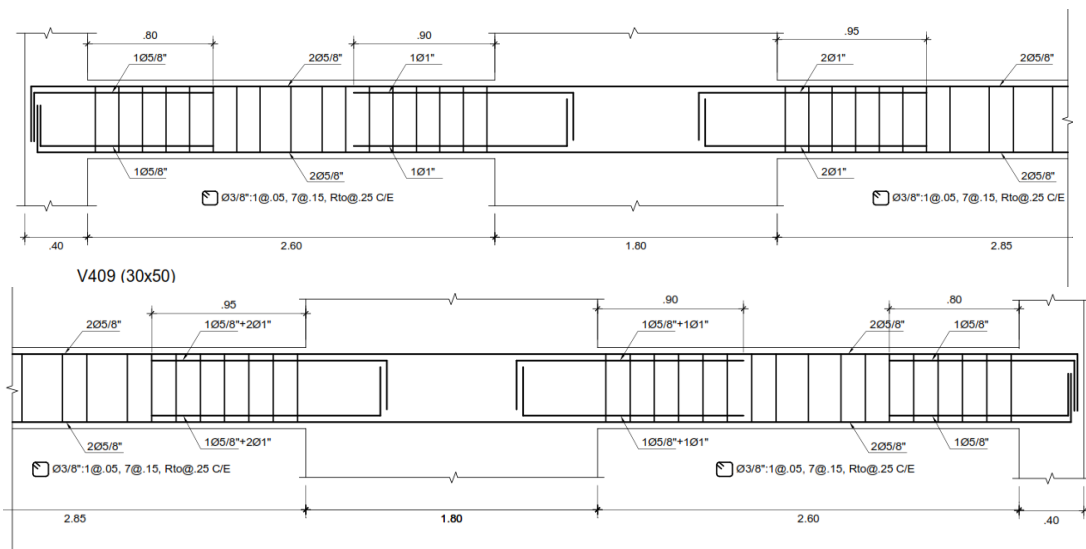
Refuerzo final en viga V409 de edificación convencional
